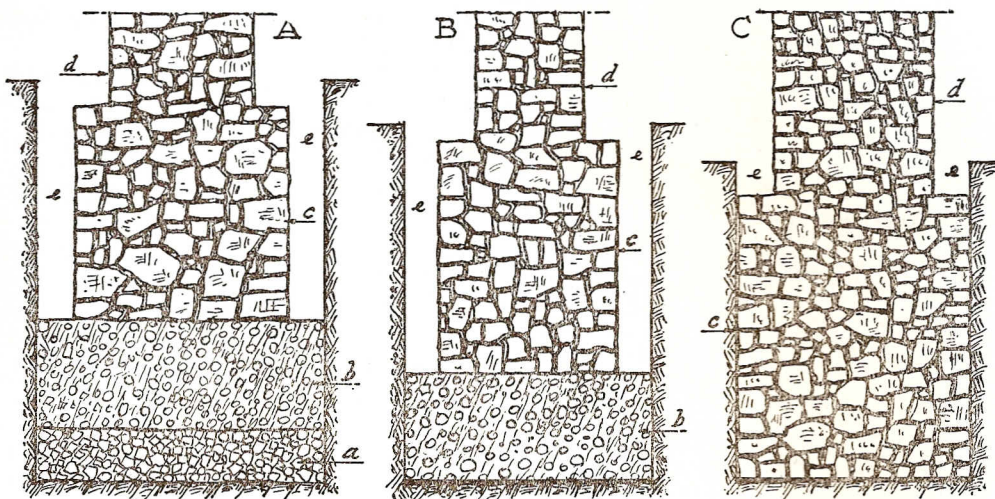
DIVERSOS TIPOS DE FUNDAÇÕES: A) FUNDAÇÃO COM SAPATA DE BETÃO SOBRE CASCALHO; B) FUNDAÇÃO COM SAPATA DE BETÃO; C) FUNDAÇÃO DE ALVENARIA SOBRE A TERRA
